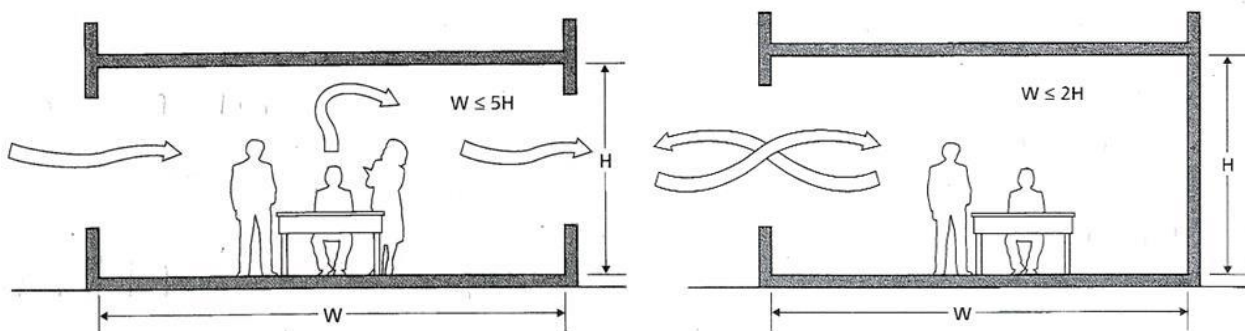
Esempi di cross ventilation (a sinistra) e single-sided ventilation (a destra)
